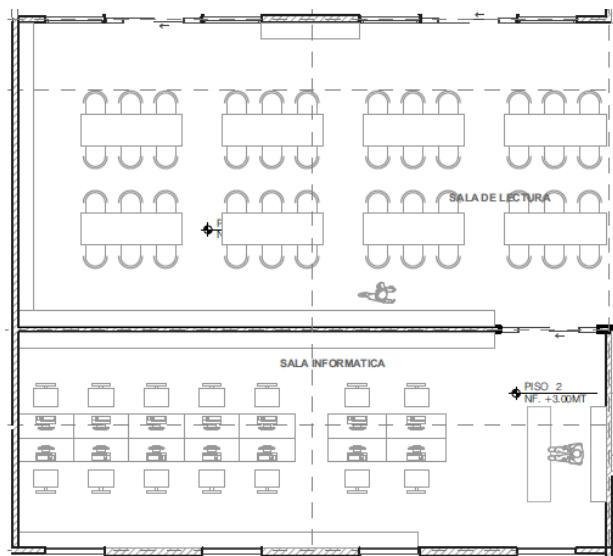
Planta zonas de lectura e informática Fuente: propia
